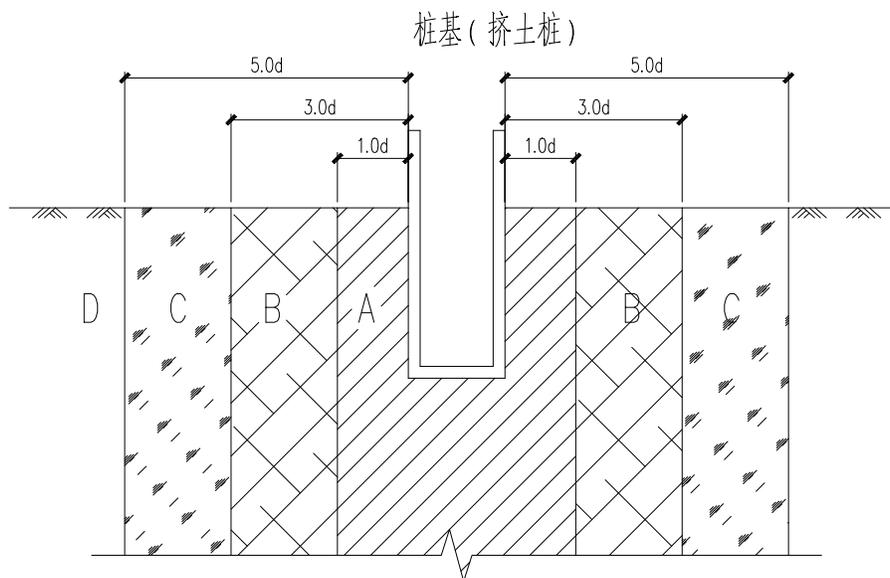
挤土桩施工的外部施工作业的工程影响分区
